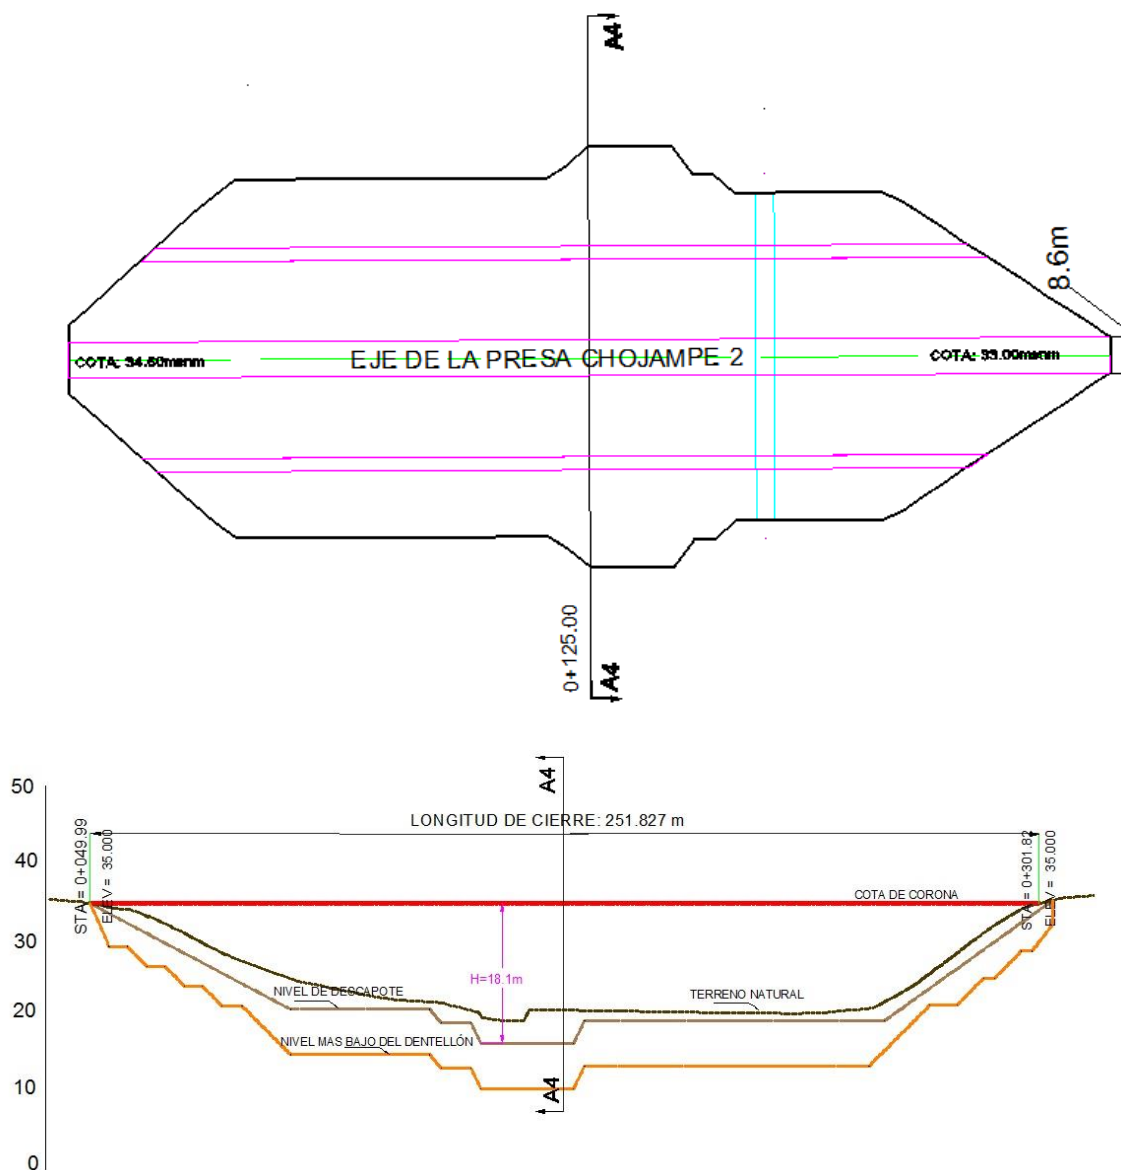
Vista en planta de la presa Chojampe 2 y sección transversal del río Calabí, donde se emplazará la presa. Siendo H la altura de la presa sobre el cimiento.
